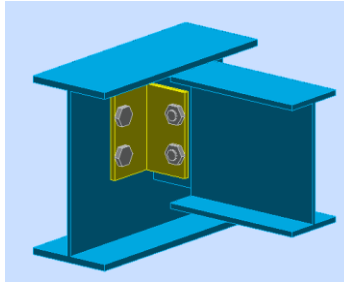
Pormenor da Ligação Viga Principal – Viga Interior (IPE 270 – IPE 200).
